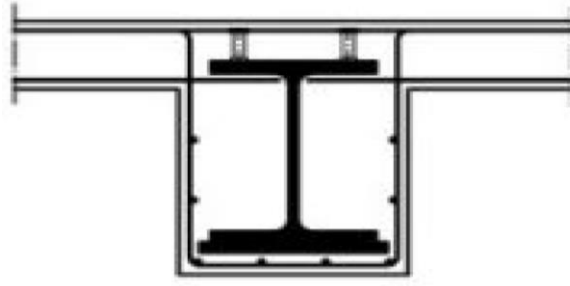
Çelik profilin içi tamamen betonla doldurulan
